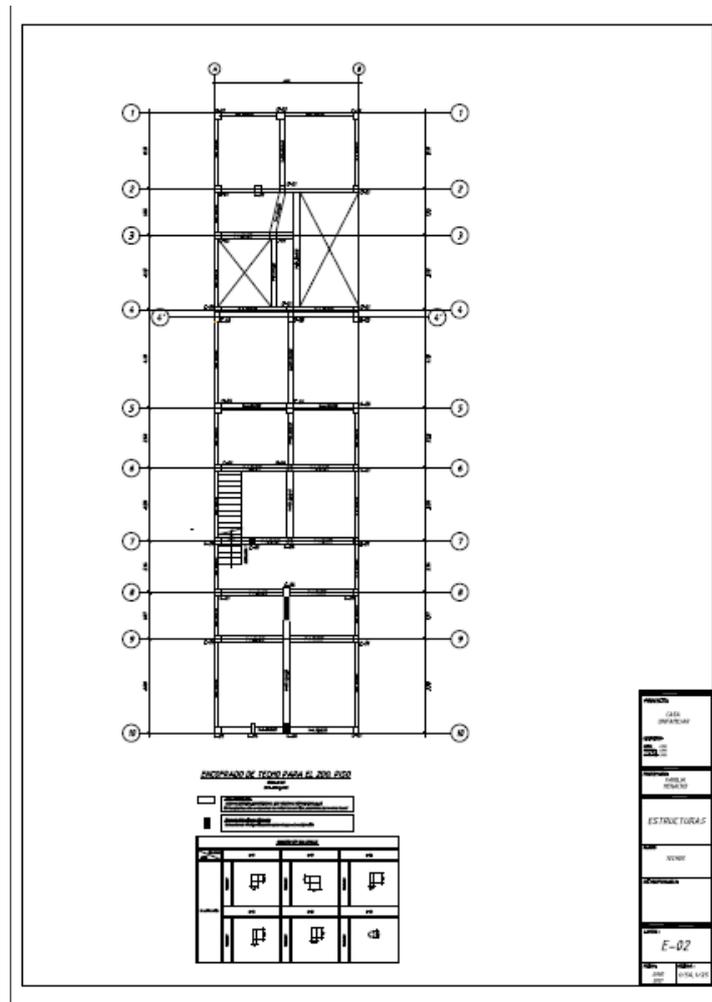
Vista de plano en planta – Estructuras de la Fam. Menacho.
